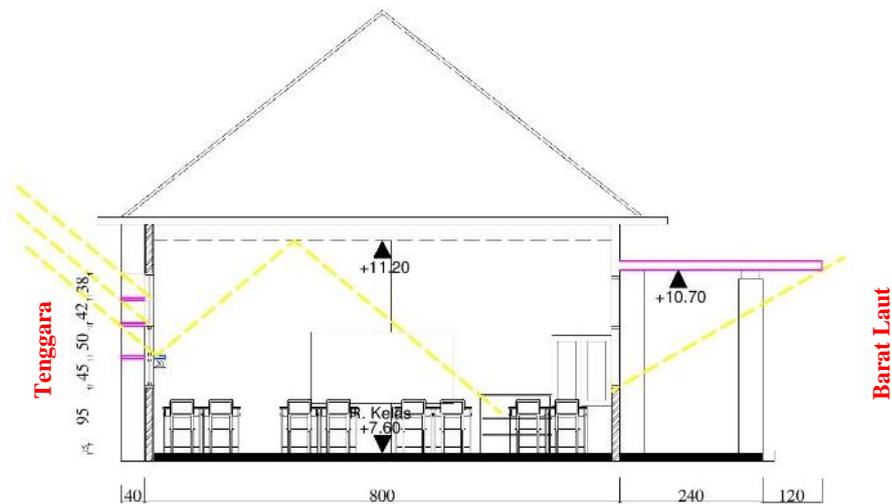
Tampak Tenggara dan Barat Laut Ruang Alternatif 1 Rekomendasi Eksternal-Internal Ruang Kelas IPA
